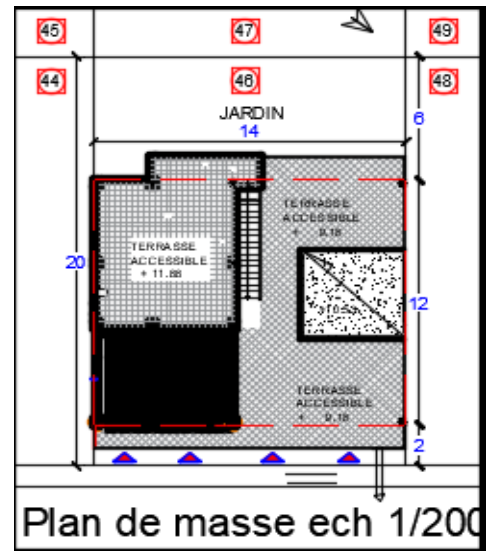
plan de masse ech 03 (source: propriétaire)
